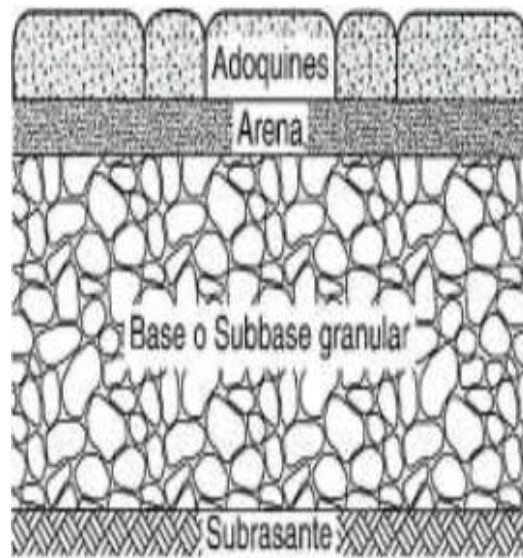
Estructura Típica de Pavimento Articulado (Adoquines). Fuente: (Higuera Sandoval, 2010)
